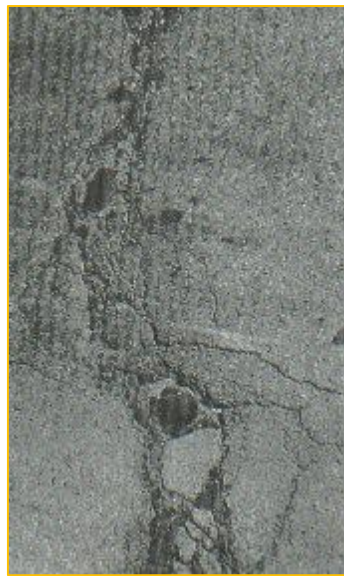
“Grietas longitudinales y transversales de Severidad Baja”
